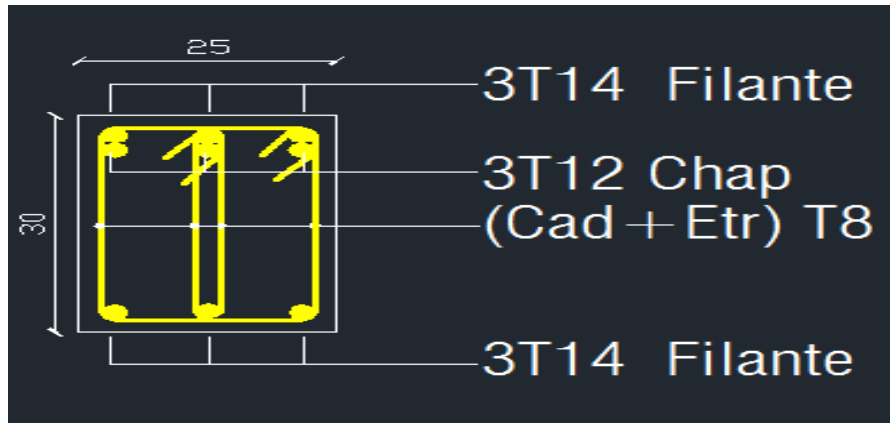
Ferrailage sur appuis d'une poutre secondaire
